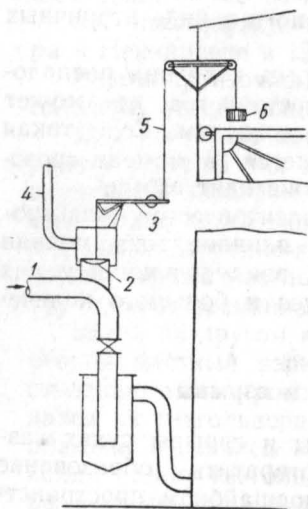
Автоматический клапан против переполнения газгольдера: 1 — подающий газопровод; 2 — клапан; 3 — рычаг клапана с грузом; 4 — свеча; 5 — трос; 6 — контргруз.
